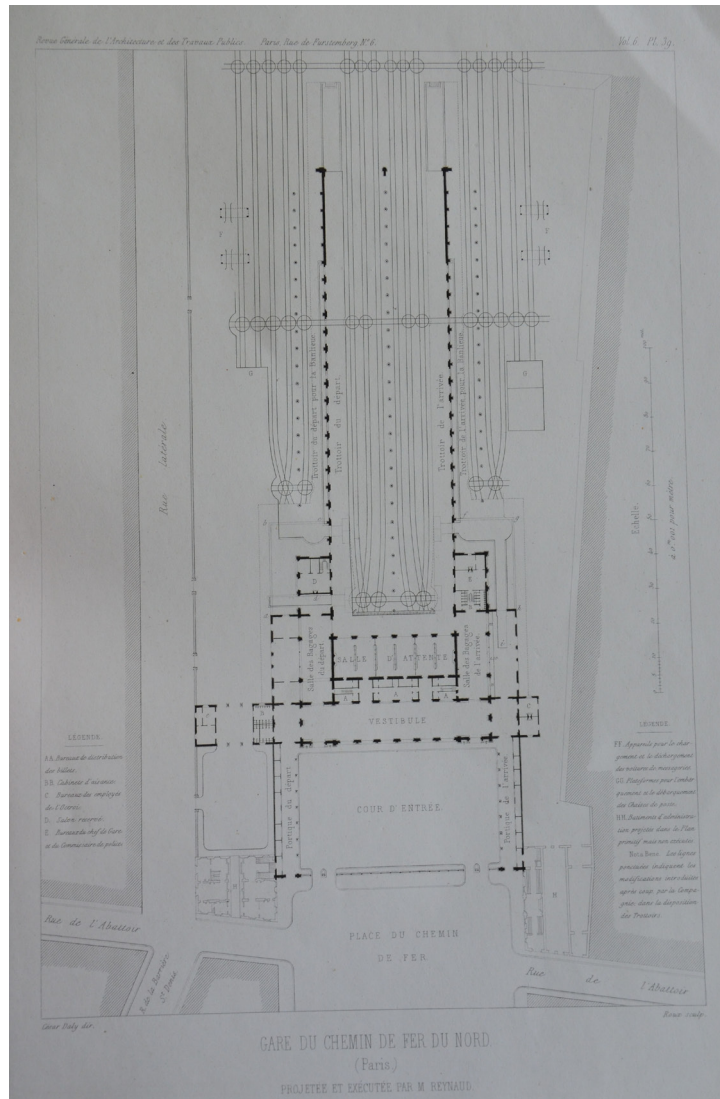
Plano de la planta de la estación del Norte de Paris. Le Gare de chemin de fer du Nord (France). Revue Générale de l'Architecture et des Travaux Publics. 1845. Vol 6, Pl 40. Foto propia
